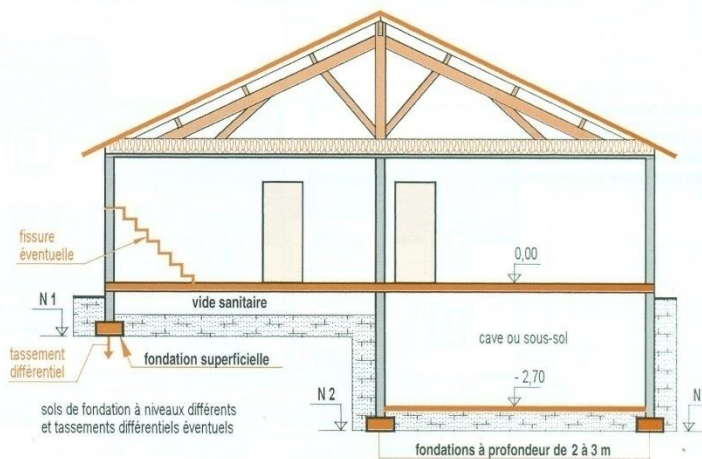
Cas d'un vide sanitaire et d'un sous-sol
